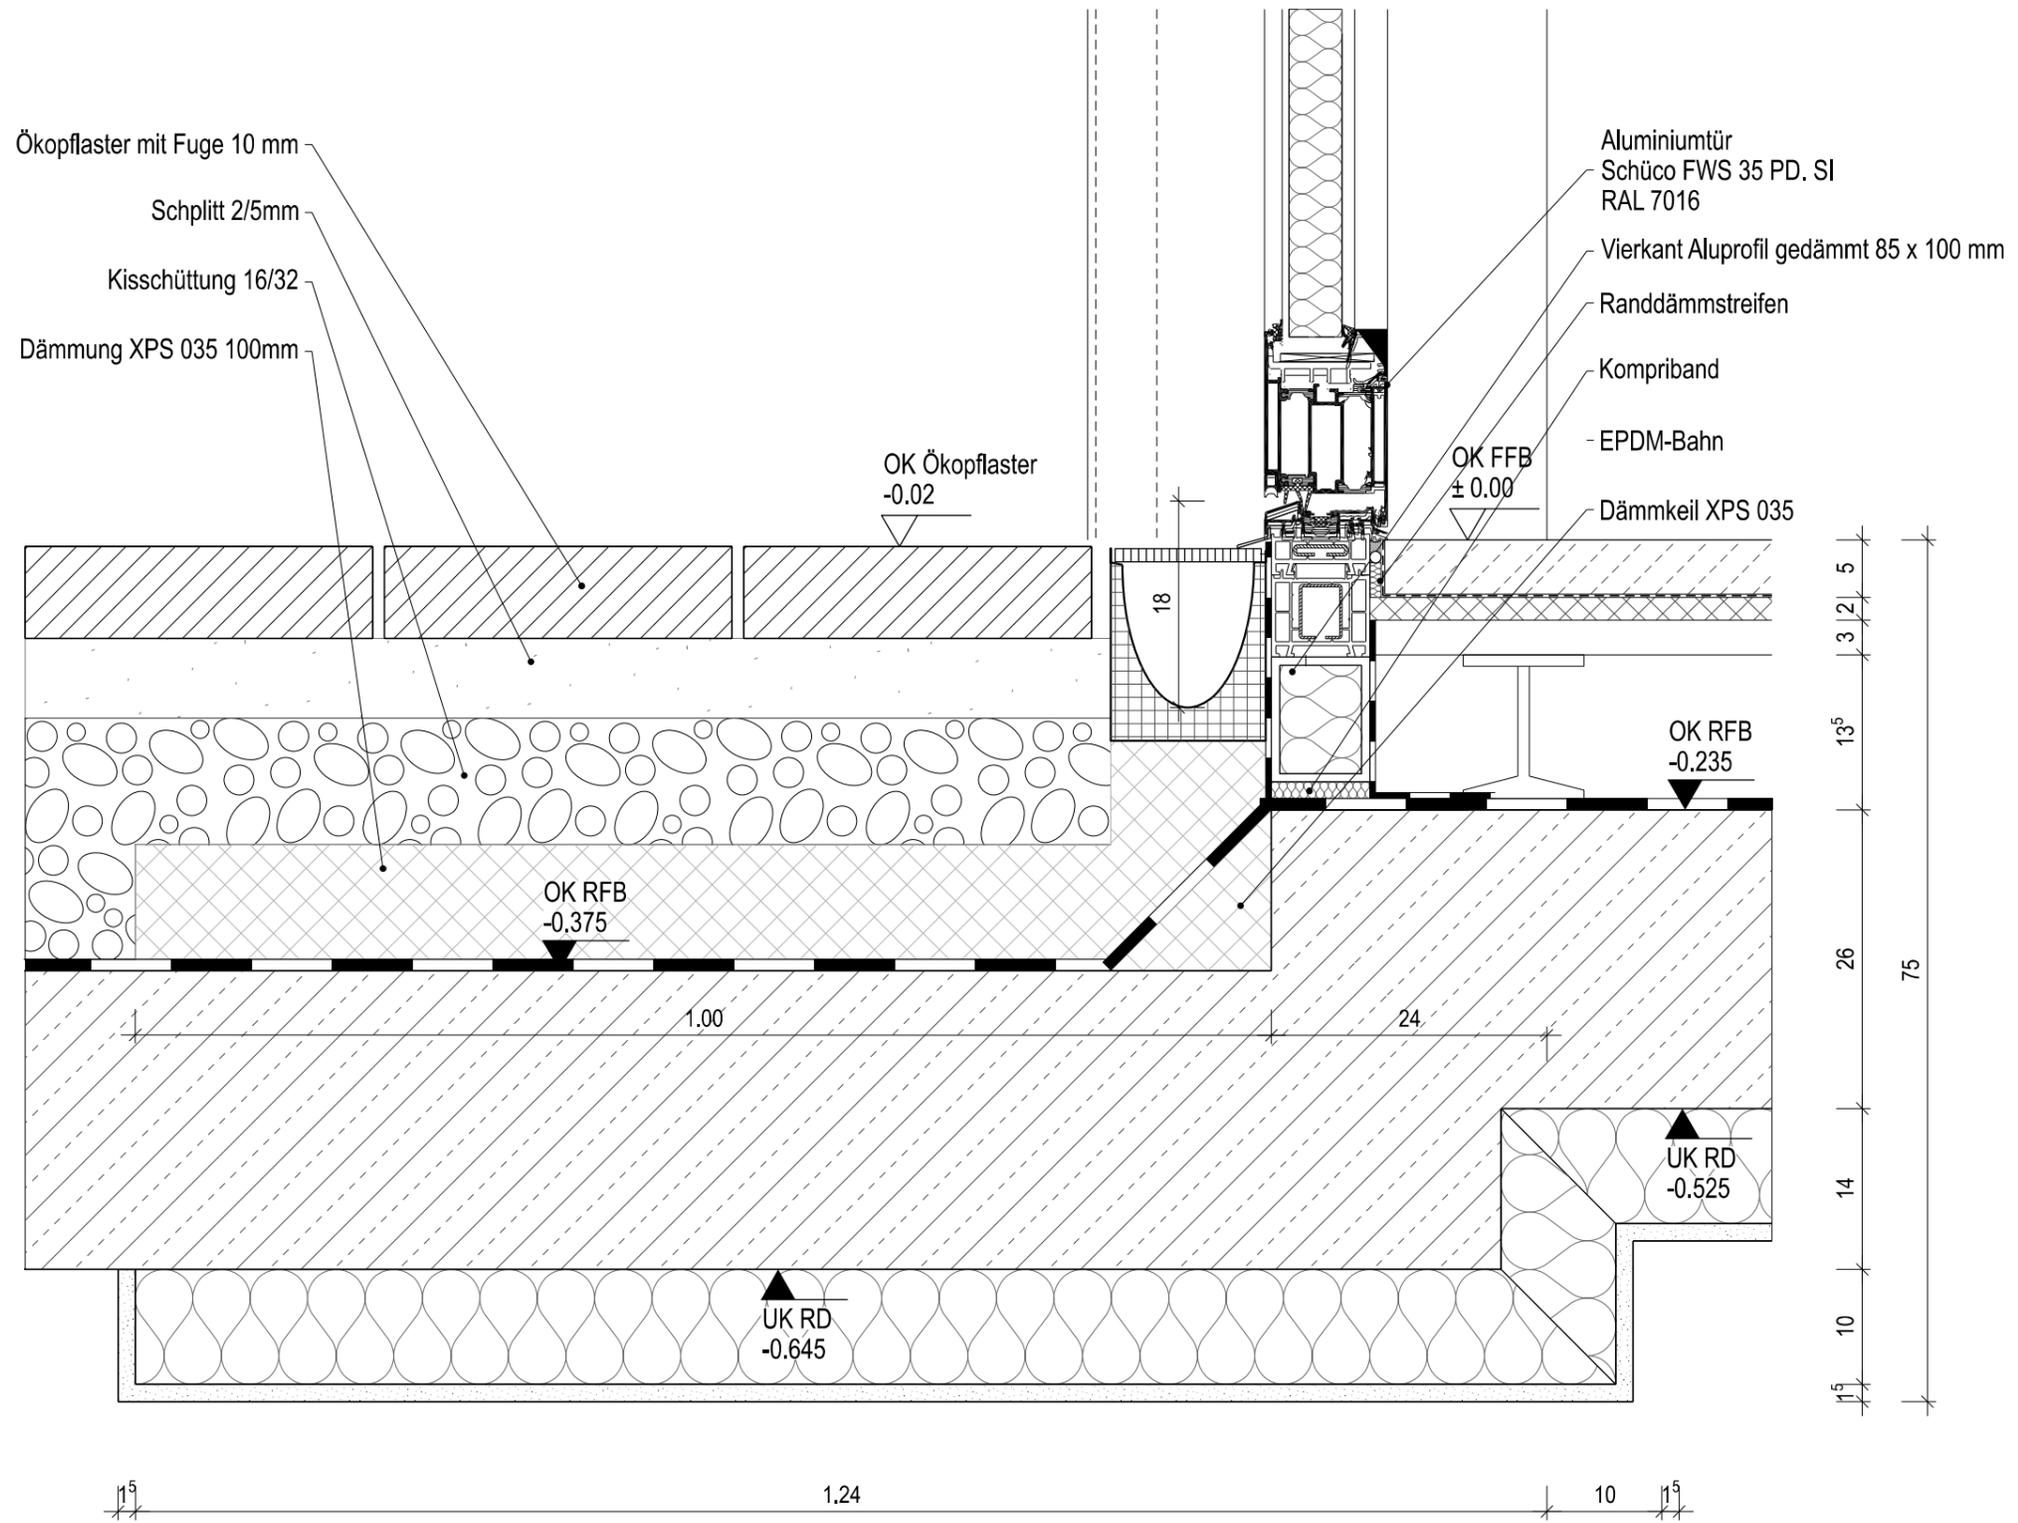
DETAIL I VORDACH ANSCHLUSS AN GEBÄUDE
